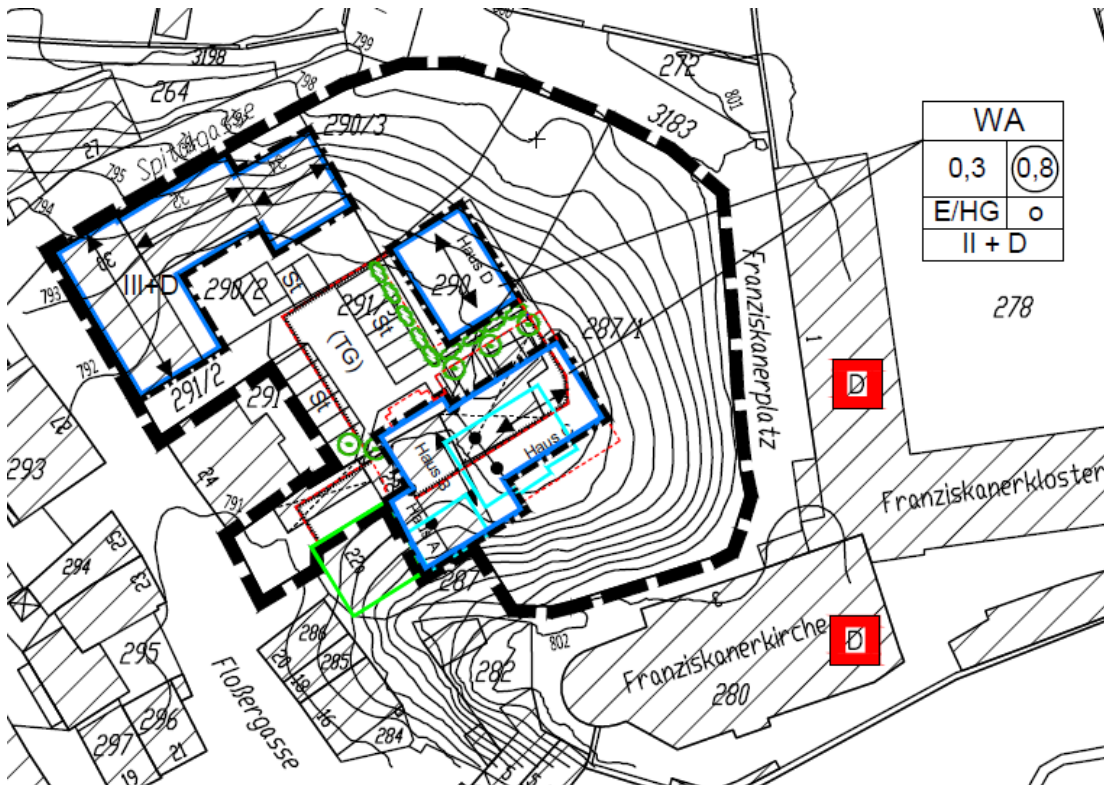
Bebauungsplan (Stand 23.03.2015), mit der dargestellten am 16.05.1994 genehmigten Bebauung – Grün = bestehendes Gebäude Haus Nr. 22a, - Hellblau = geplante Garage und Wohnhaus, Bauschein BVZ Nr. 807/93, siehe auch Anlage 3 zu dieser Begründung
